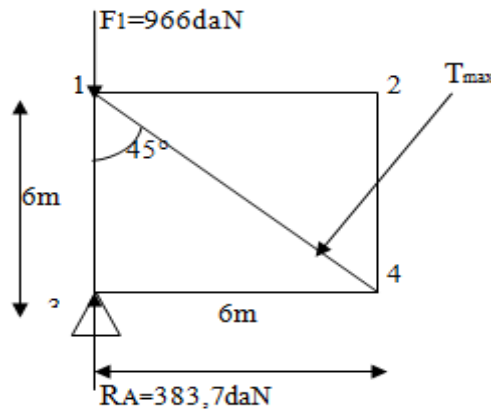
schéma statique d'une partie de la poutre au vent.
